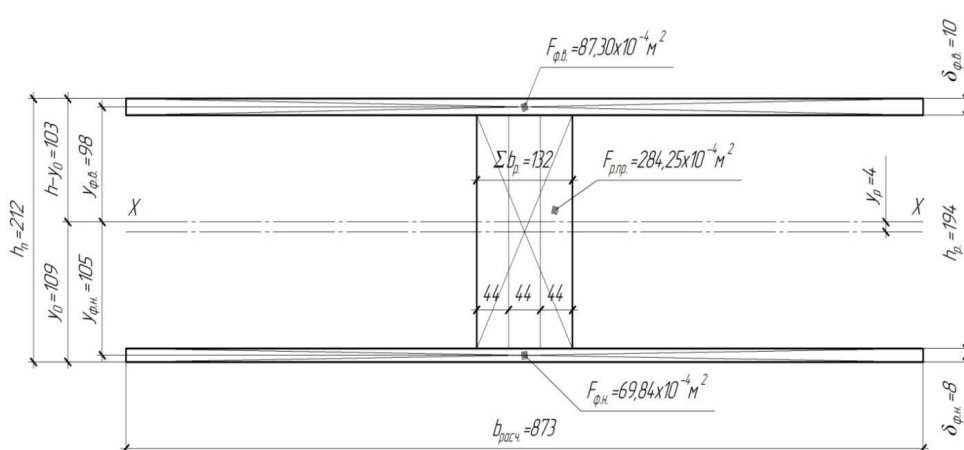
Расчетное поперечное сечение плиты покрытия
